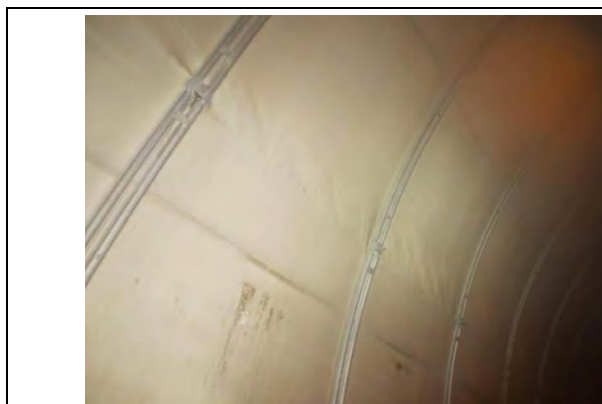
Tunnelkledning rett innenfor vestre portal.
